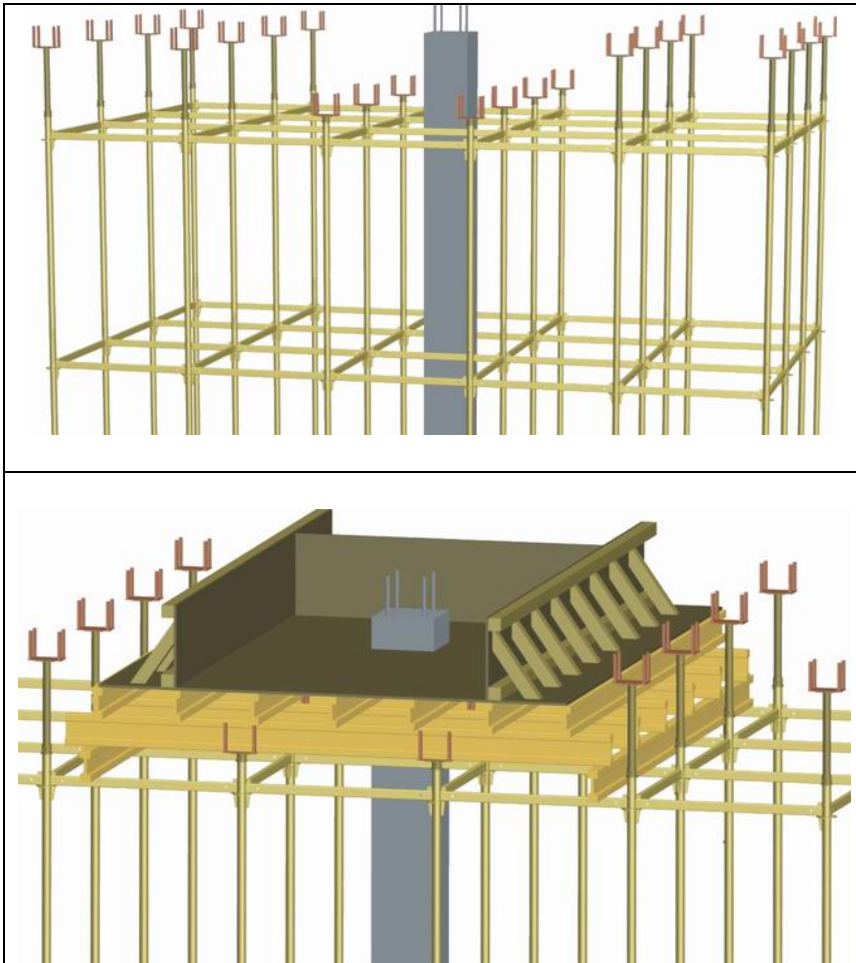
Монтаж опалубки под разновеликие ж.б. балки.
